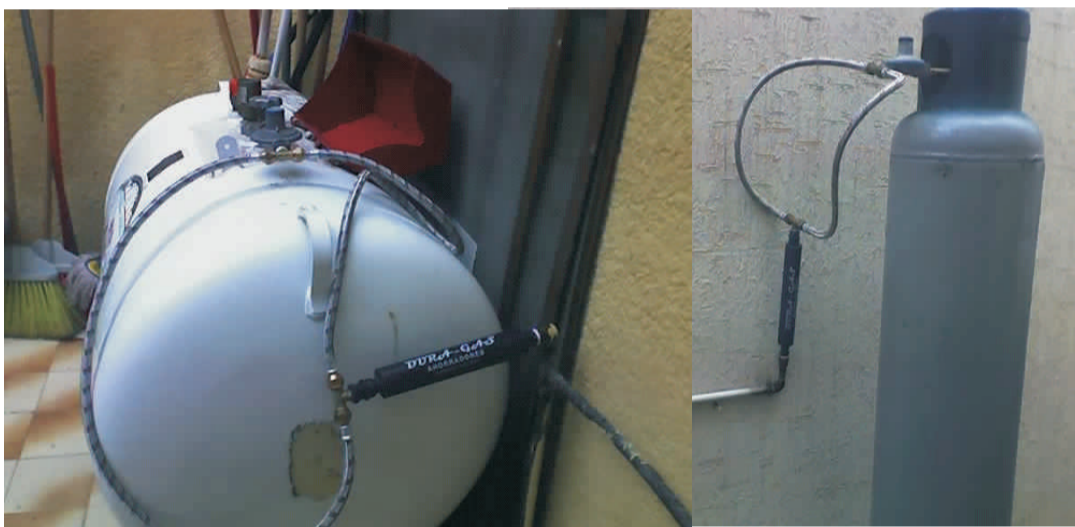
Dispositivo instalado en regulador y tubería de gas.
